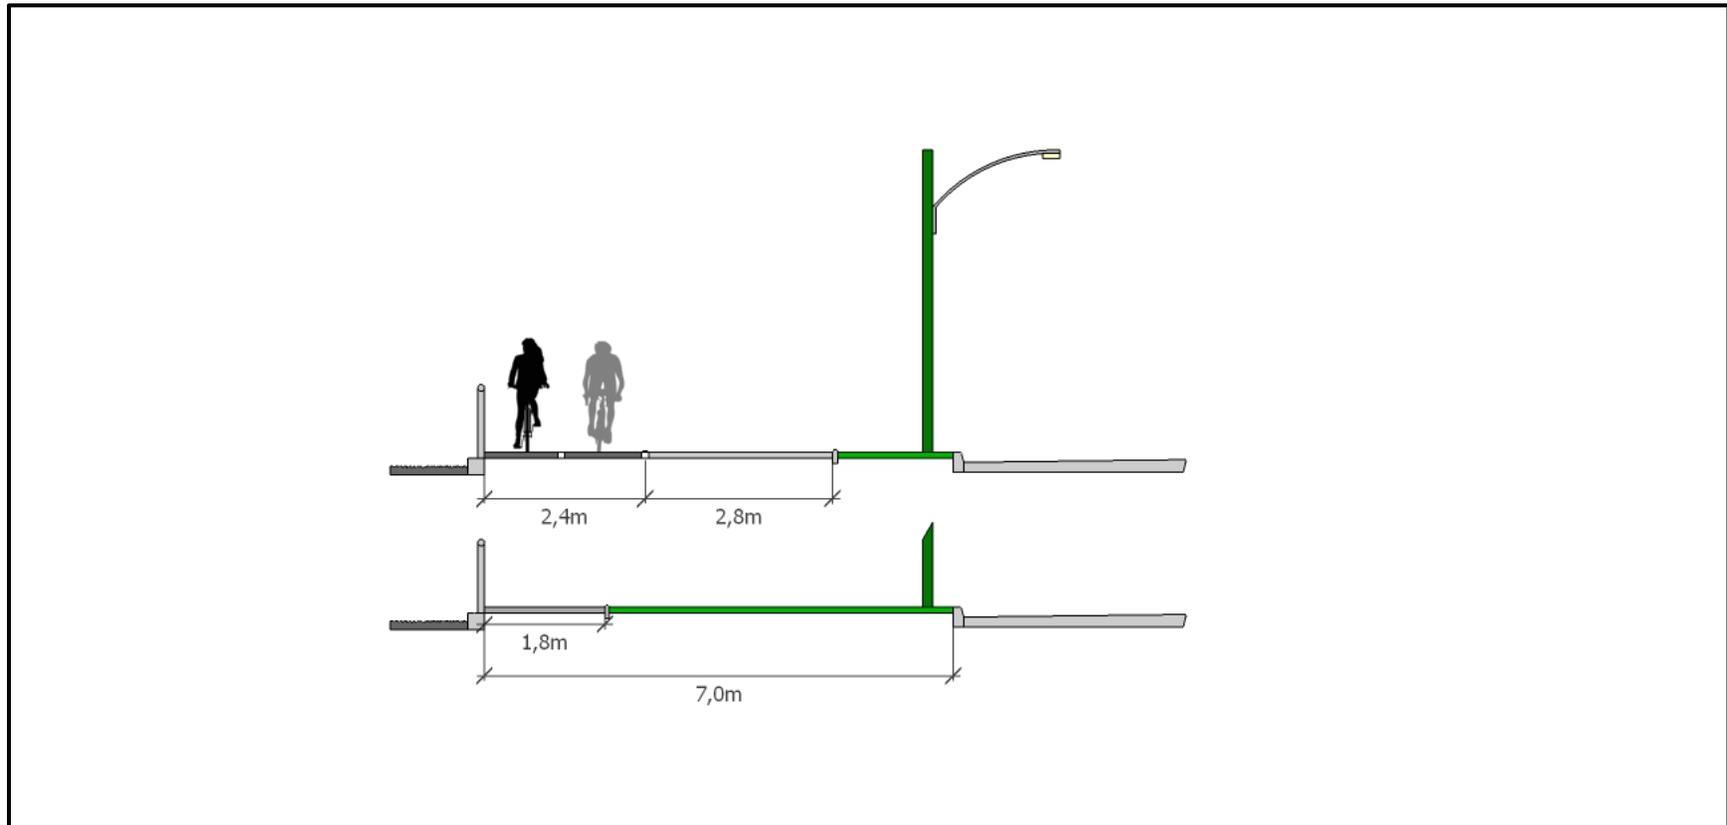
Nuevo Perfil Transversal Eje A (Av. España) / Sector A2 / 1 (antes-después)
